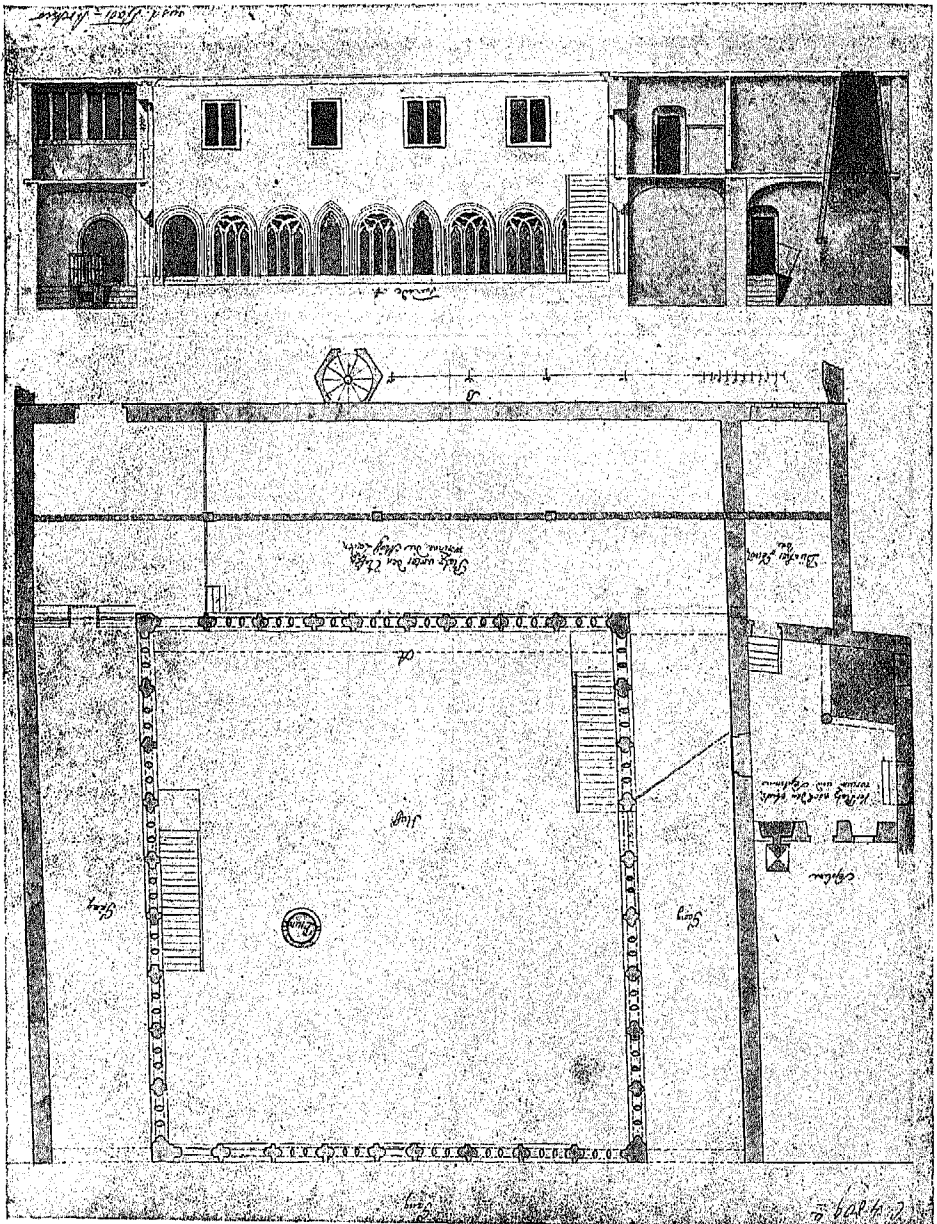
281. Ehemaliges Barfüsser-Kloster; Grundriss und Schnitt des Kreuzganges.
